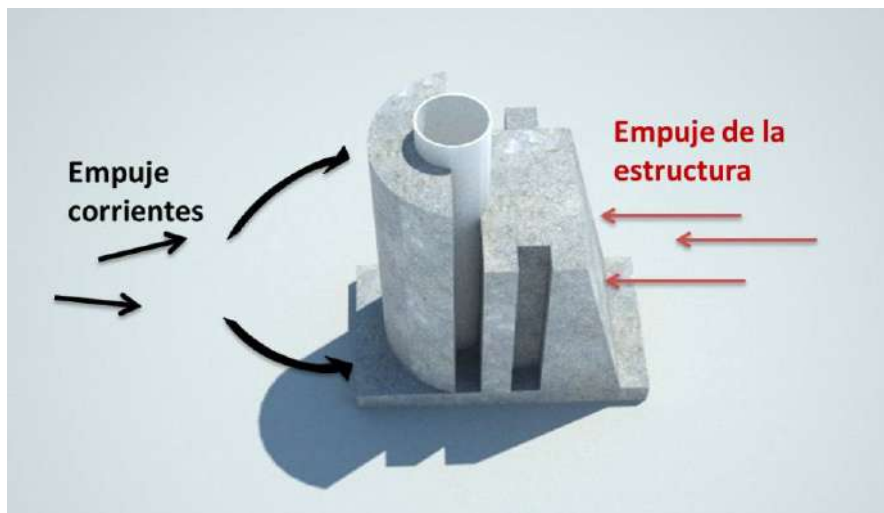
Elemento estructural diseñado tomando en cuenta las características del sitio.
